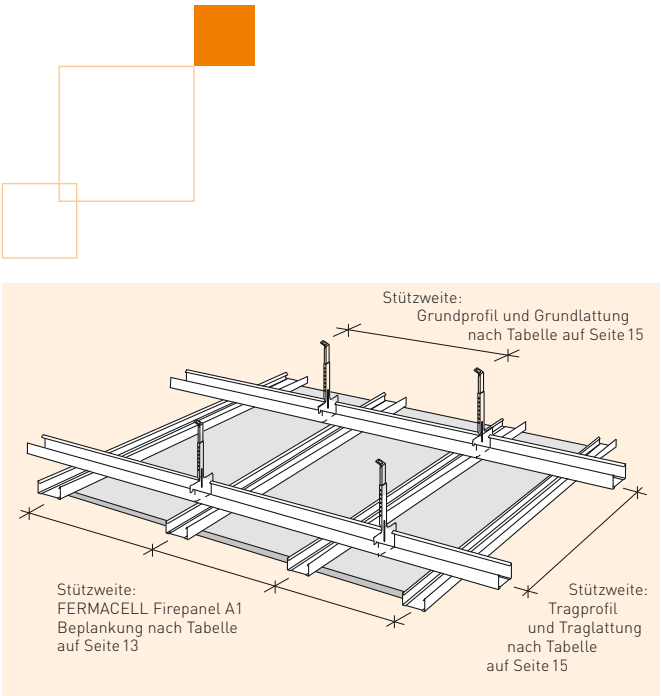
Abgehängte Unterdecke mit Anordnung der Grund- und Tragprofilen (Holz-Unterkonstruktion sinngemäß)
